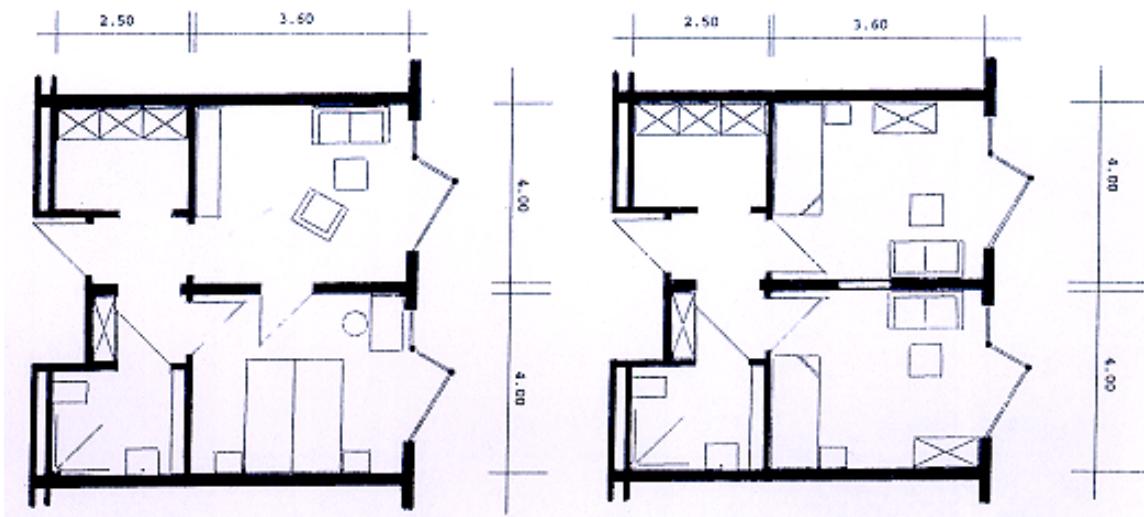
Beispiele flexibler Grundrisse von Pflegezimmern
